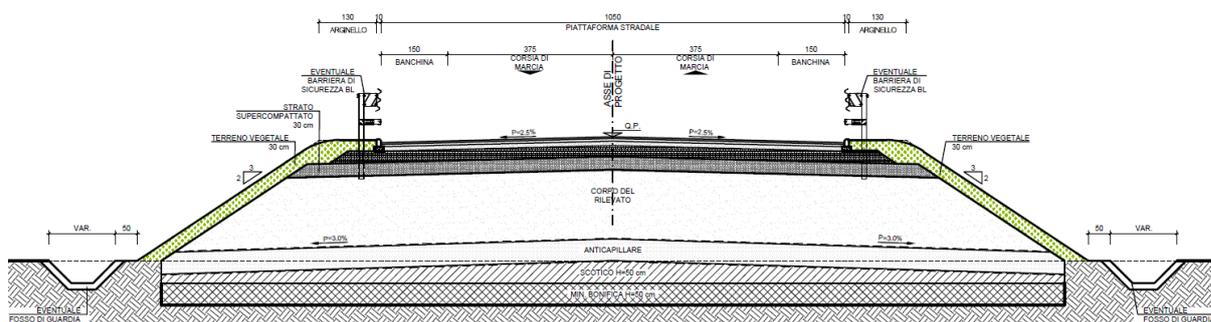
Sezione tipo in rilevato Strada C1 Extraurbana Secondaria
